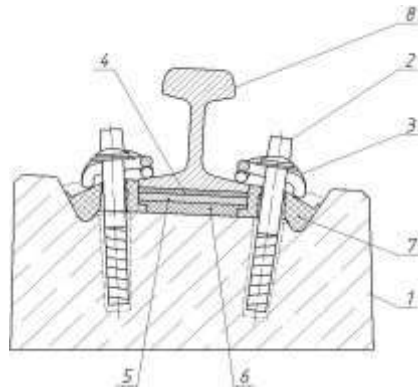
Блок опорный железобетонный с рельсовым креплением Vossloh 300 UTS: 1 – блок опорный железобетонный; 2 – рельсовый шуруп; 3 – клемма упругая; 4 – прокладка подрельсовая; 5 – плита опорная; 6 – плита эластичная; 7 – плита углонаправляющая; 8 – рельс P50
